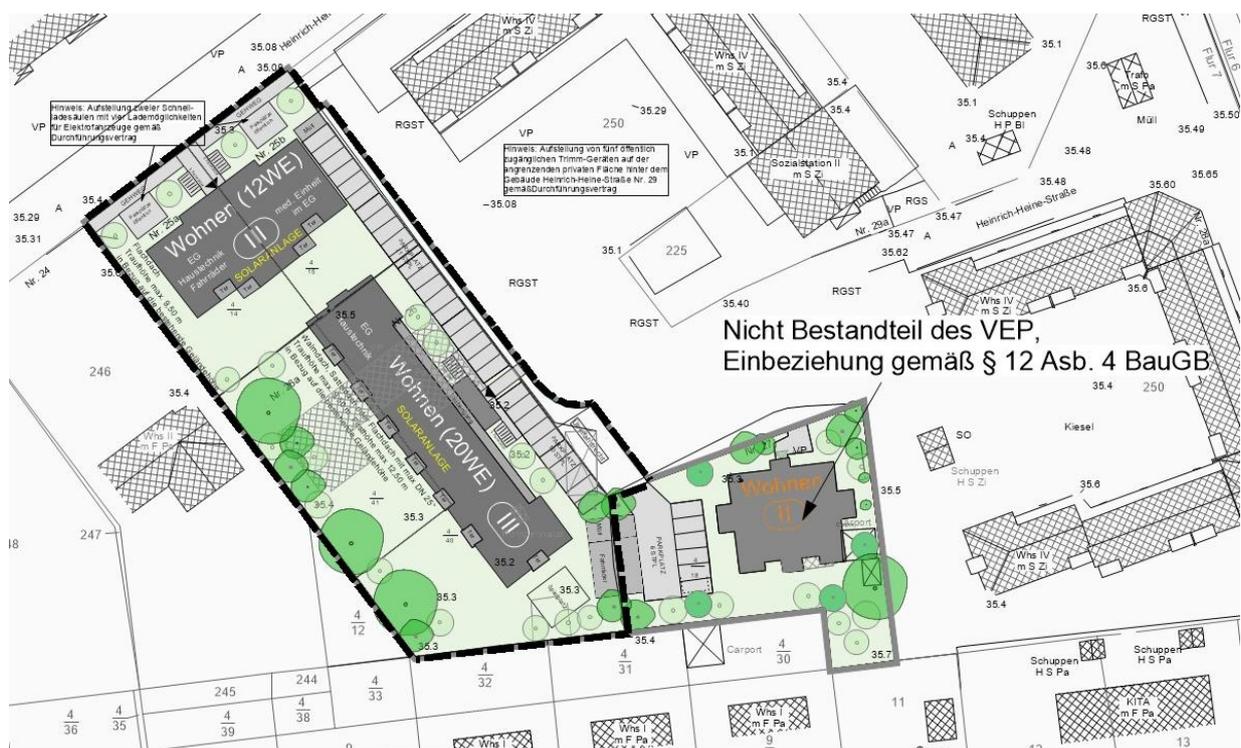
Vorhaben- und Erschließungsplan ²⁰
